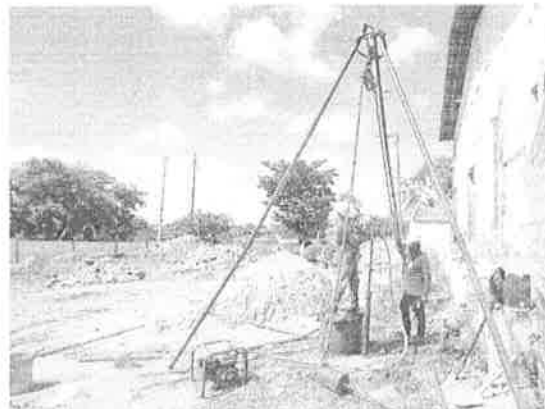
Detalhe da operação de lavagem para atingir a cota de amostragem do furo de sondagem.
